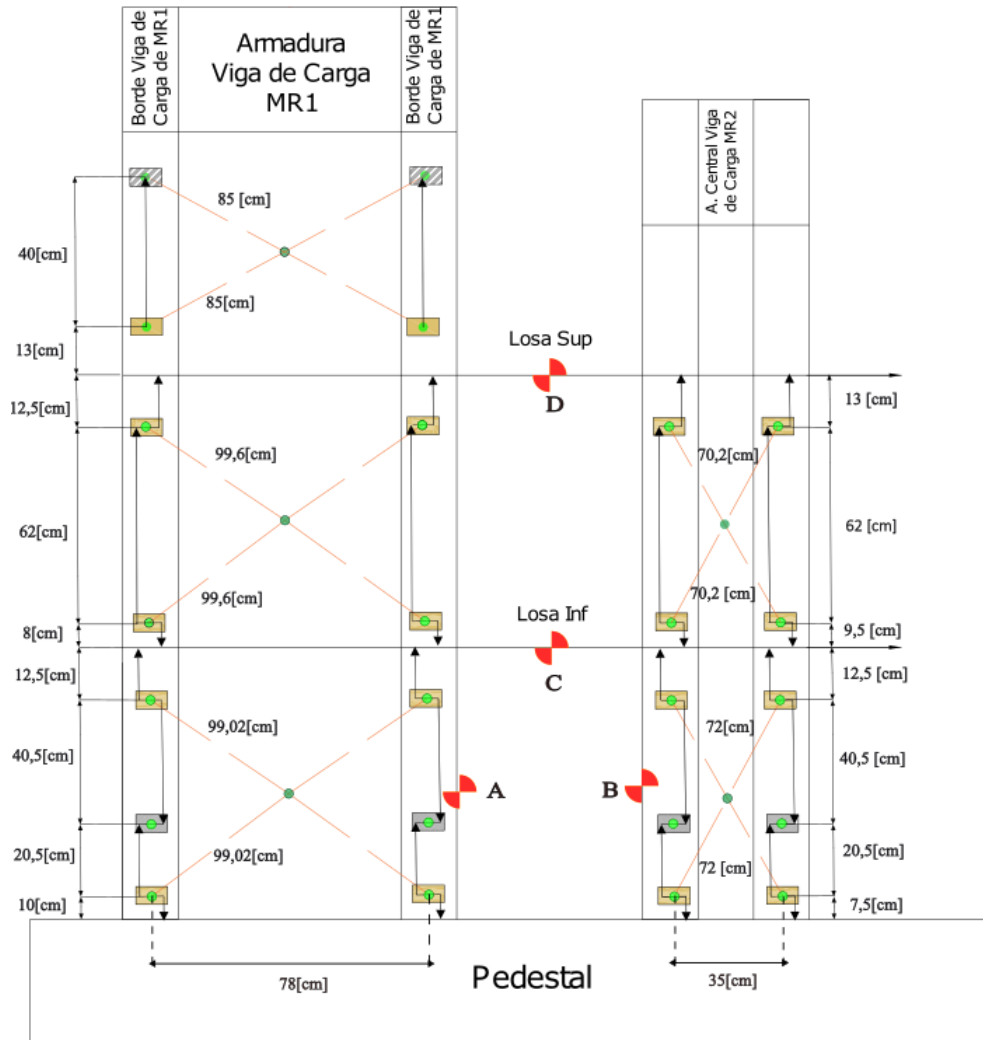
Esquema de Disposición de LVDT'S en las Caras Interiores del Muro
